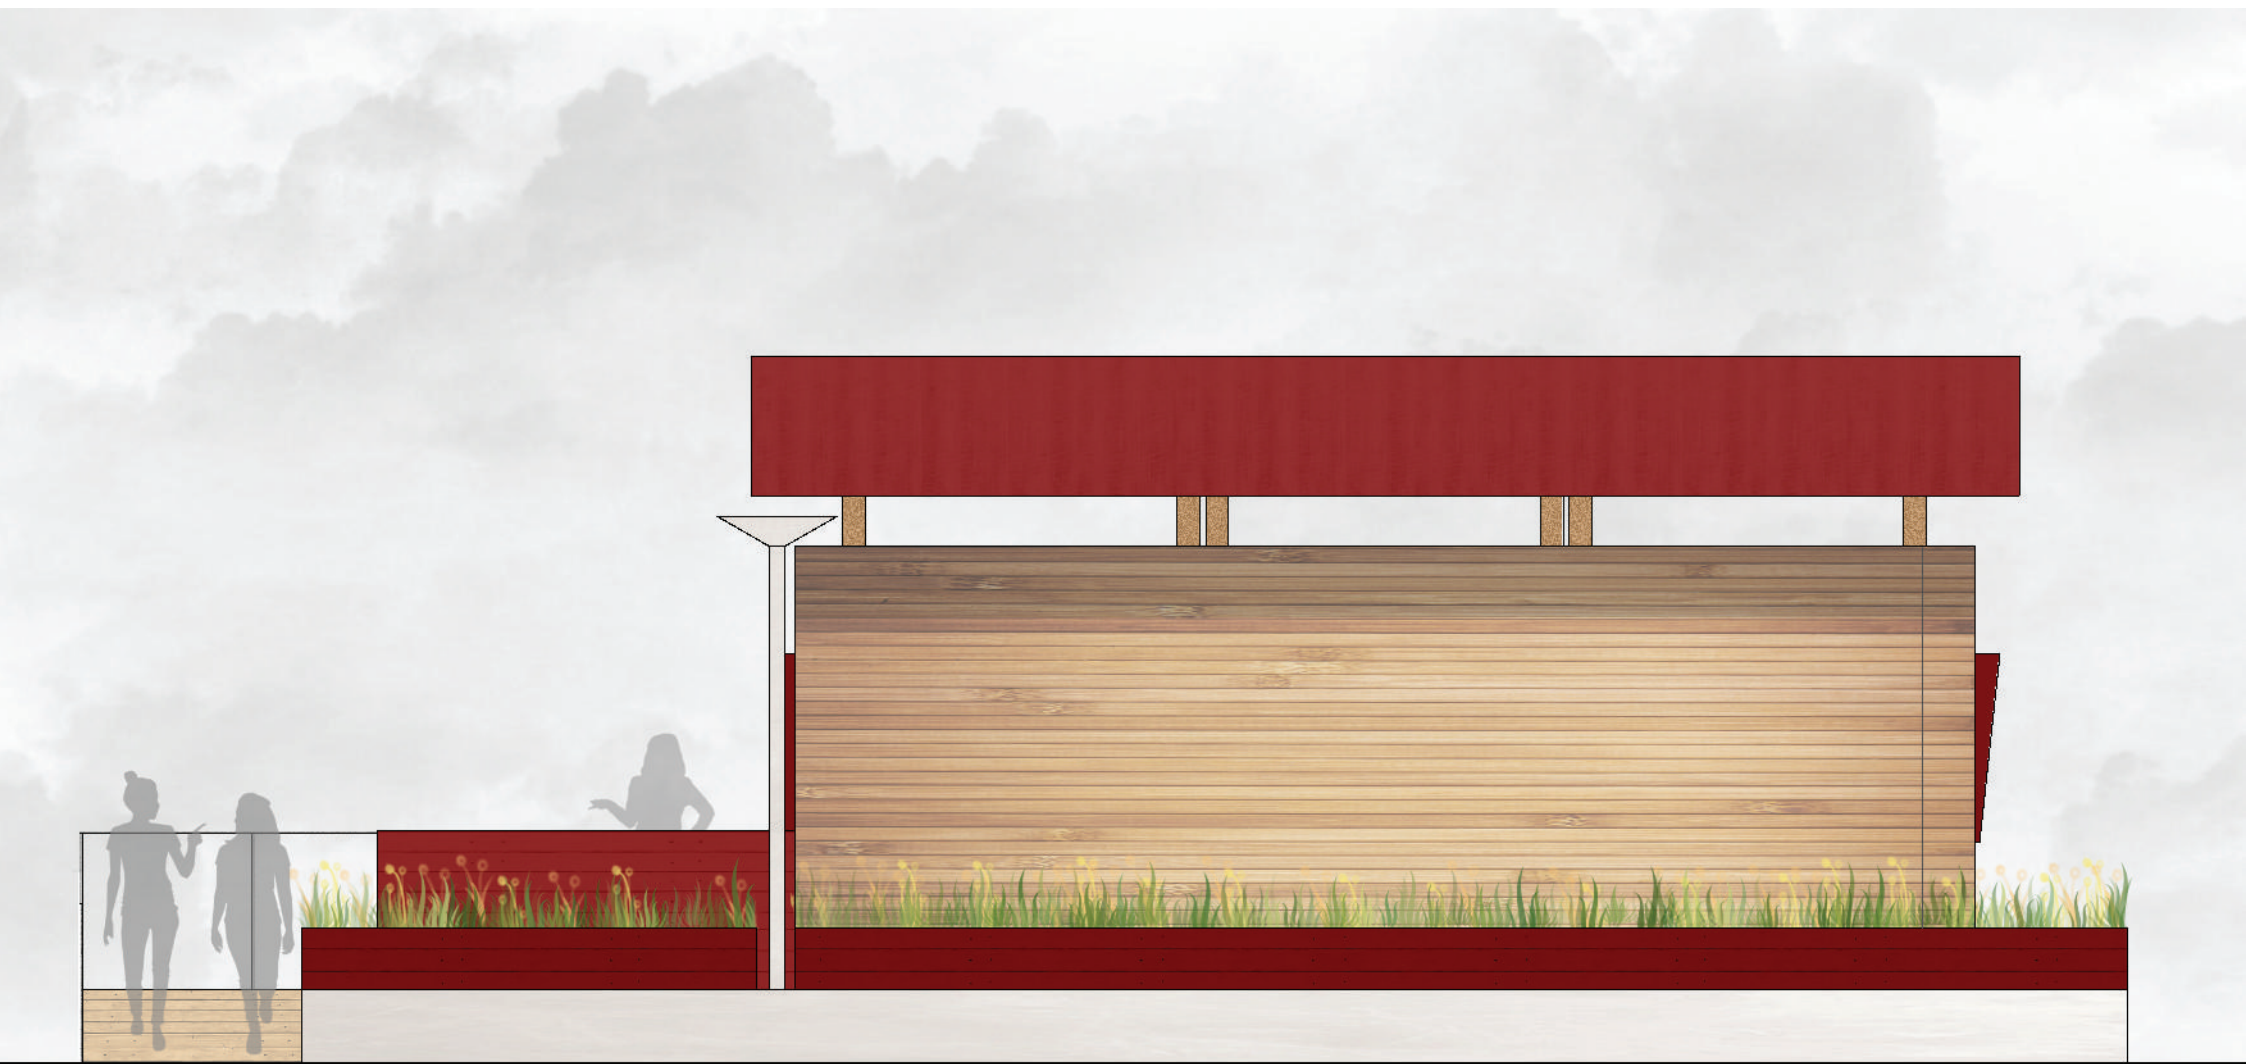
\_ Prospetto est \_ Scala 1:50
